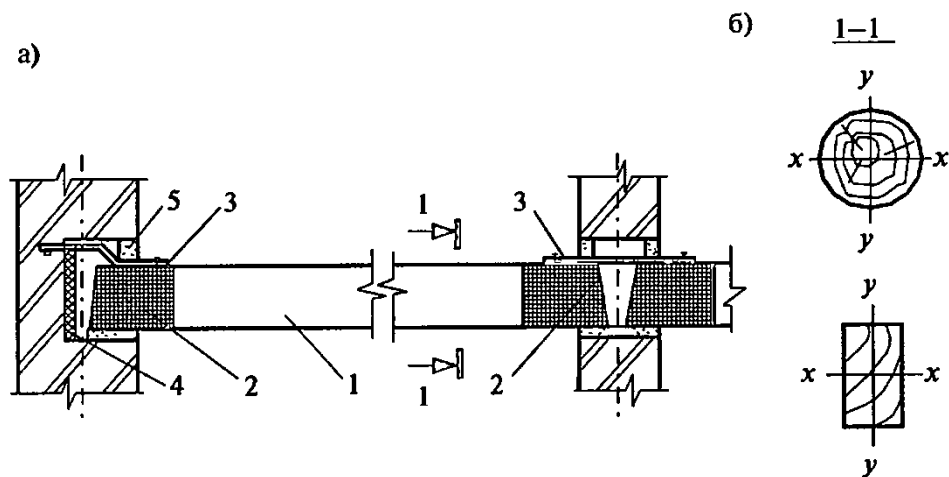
Вариант опирания деревянной балки на кирпичные стены:
